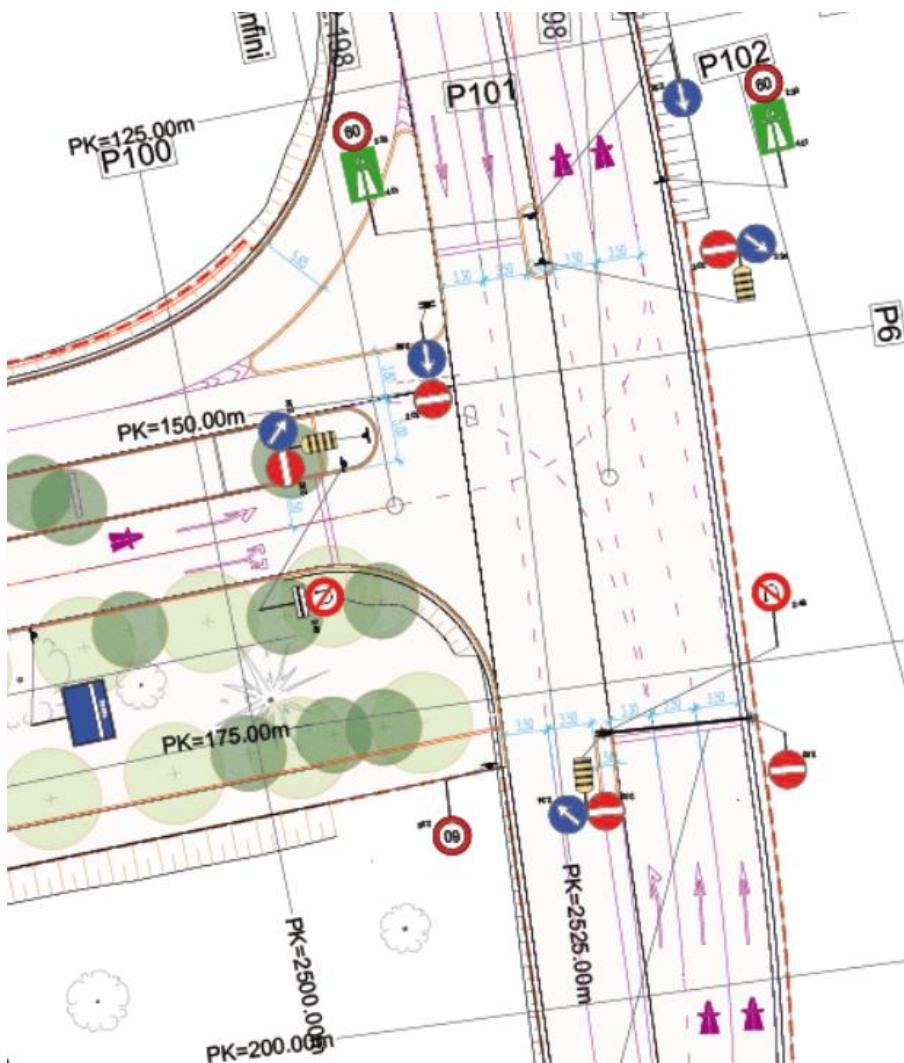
Extrait plan de marquage et signalisation verticale PROJET – Carrefour bretelle N01
